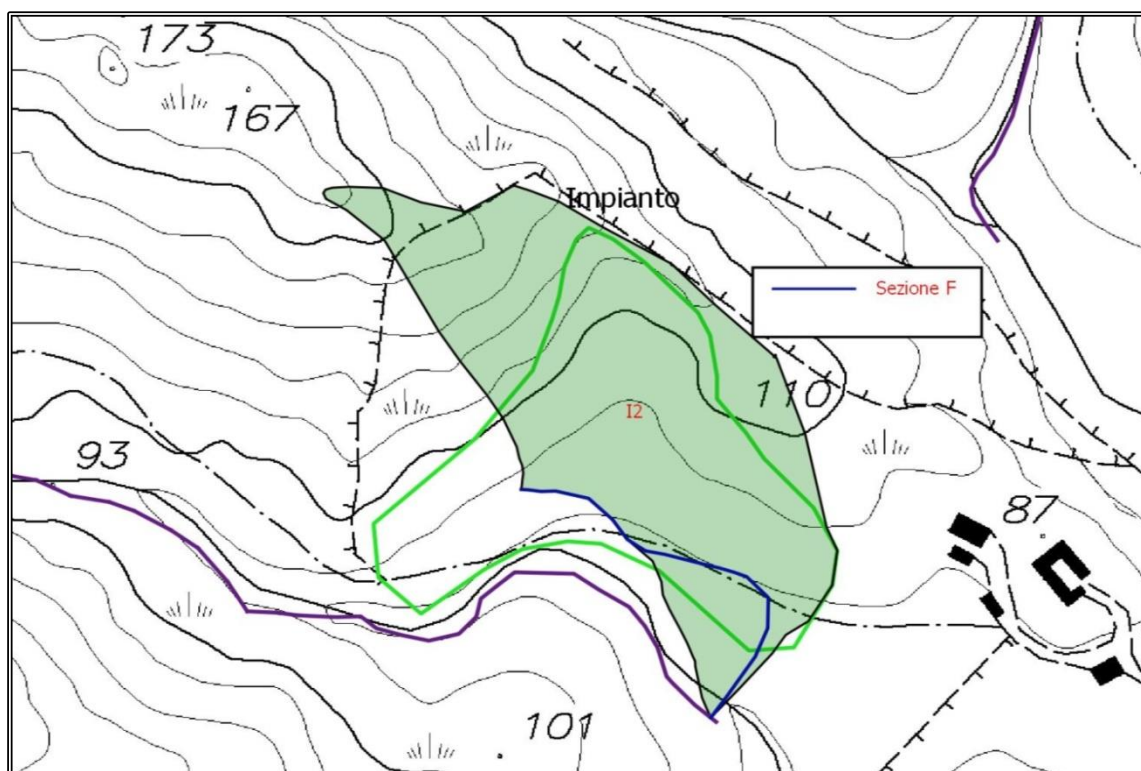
Schema della rete di drenaggio, con tipologia di sezione trasversale di progetto (Area Impianto I2).
